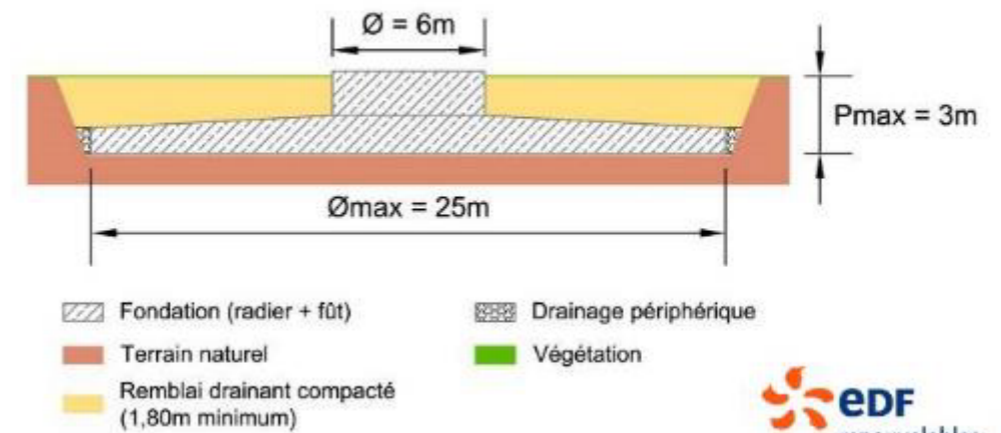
Principe de dimensionnement d'une fondation d'une éolienne
